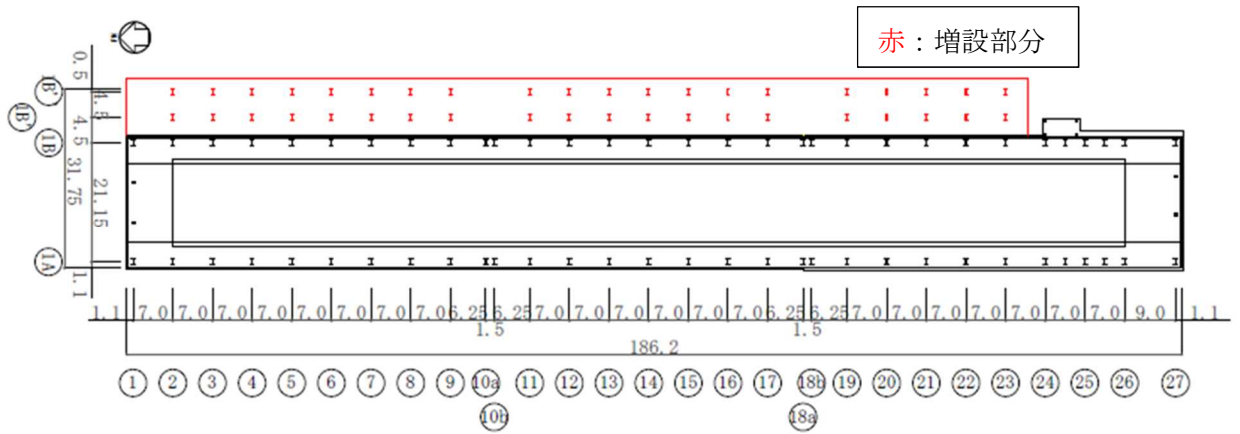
(2) 1 階平面図 (G. L. +0.635) (単位 : m)
